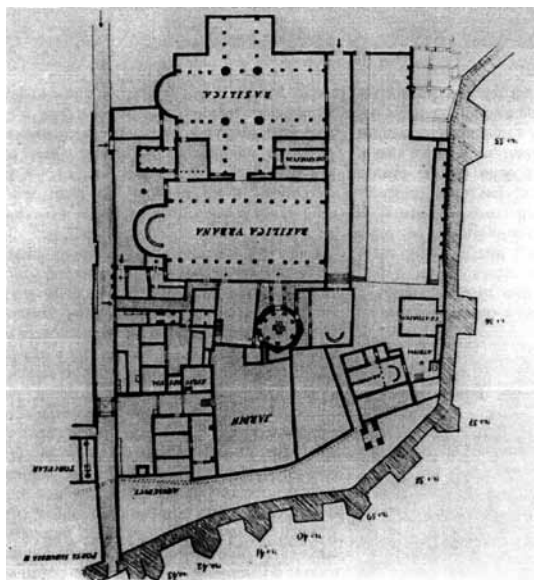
Planimetria dell'episcopo di Salona (da BERTACCHI 1985)
